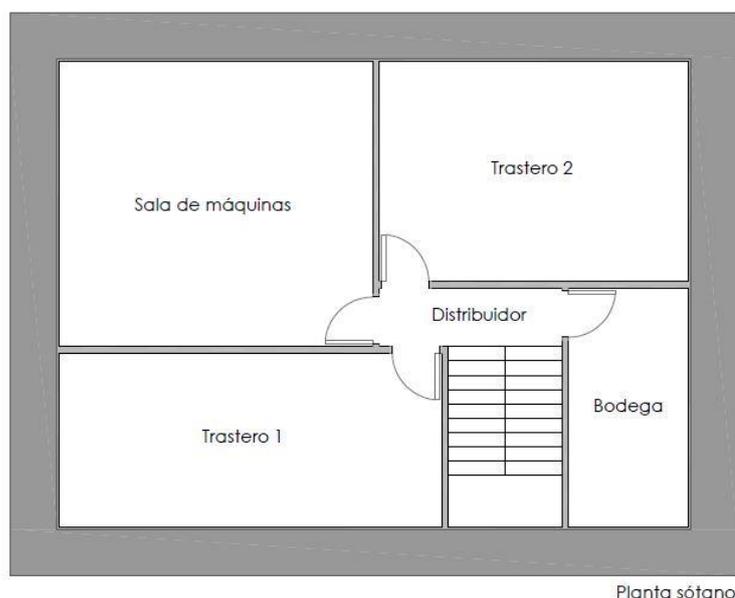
Distribución planta sótano. Fuente: Elaboración propia.
